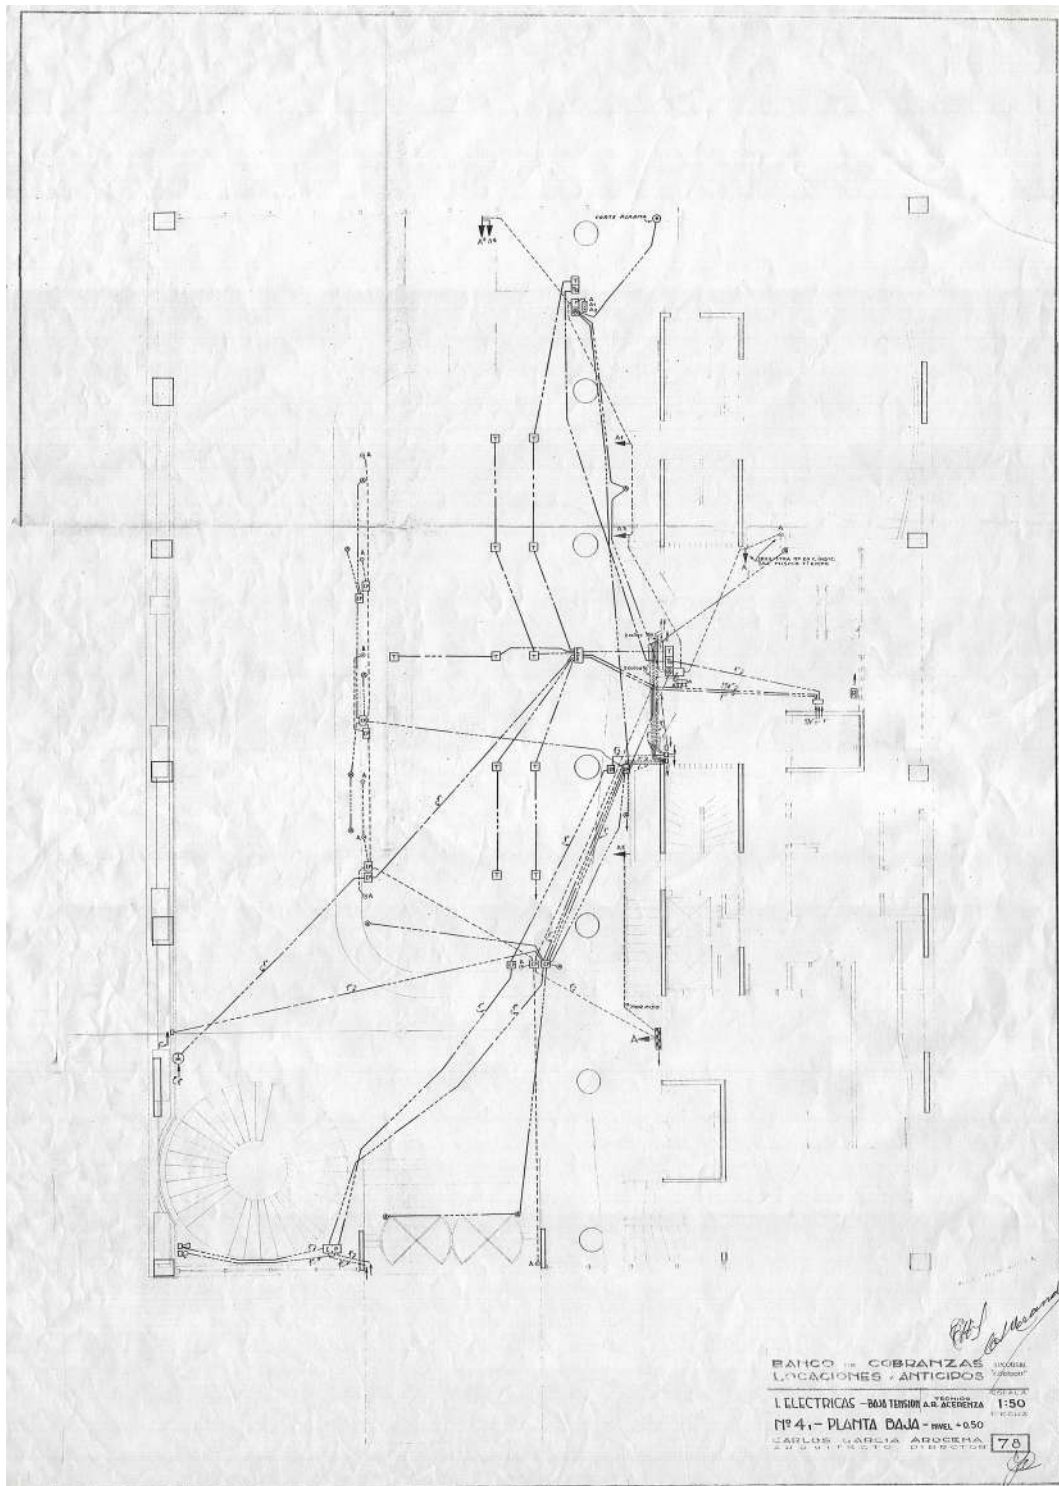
Lámina 78 del proyecto ejecutivo del BCLA: proyecto eléctrico de tensiones débiles de planta baja.
